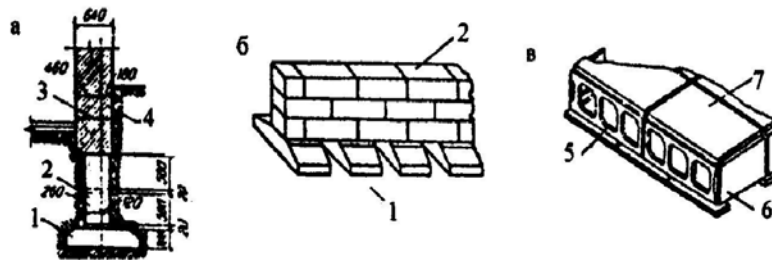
Збірні бетонні стрічкові фундаменти:
